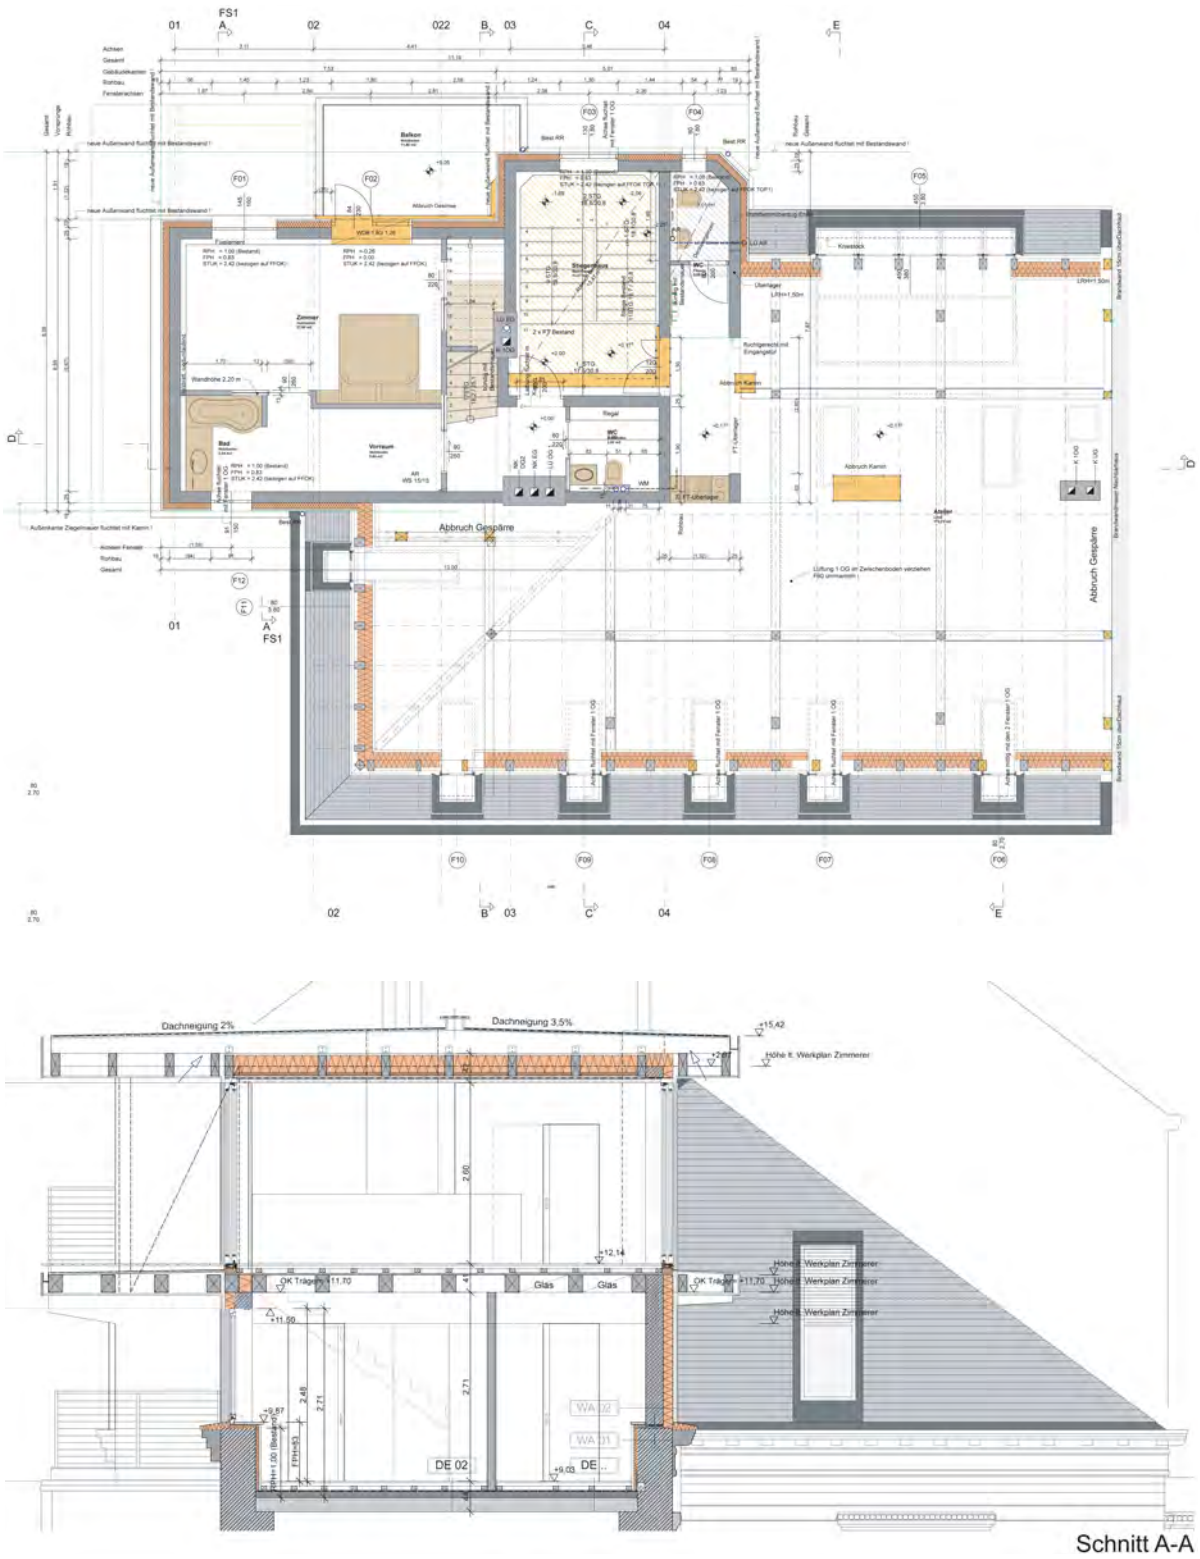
Grundriss Dachgeschoss 1 und Schnitt A-A
